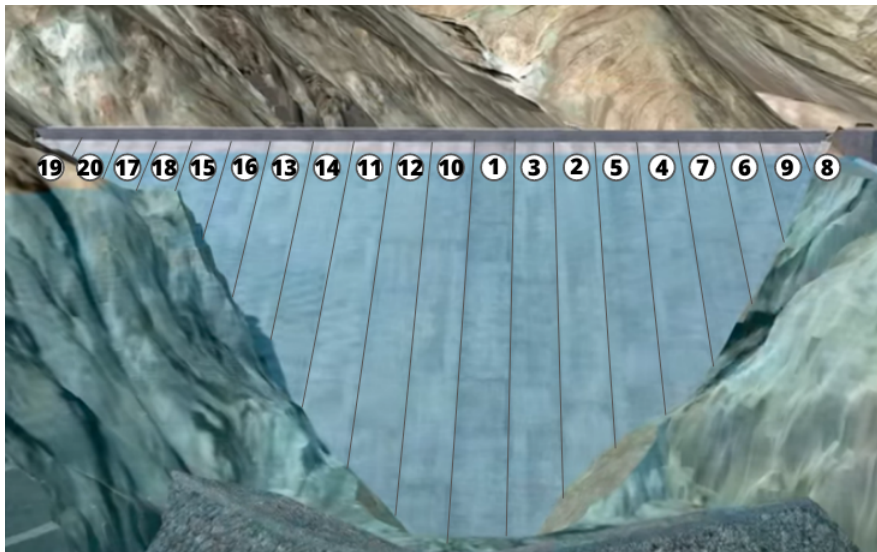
Orden del hormigonado de losas *Fuente:* Elaboración propia
